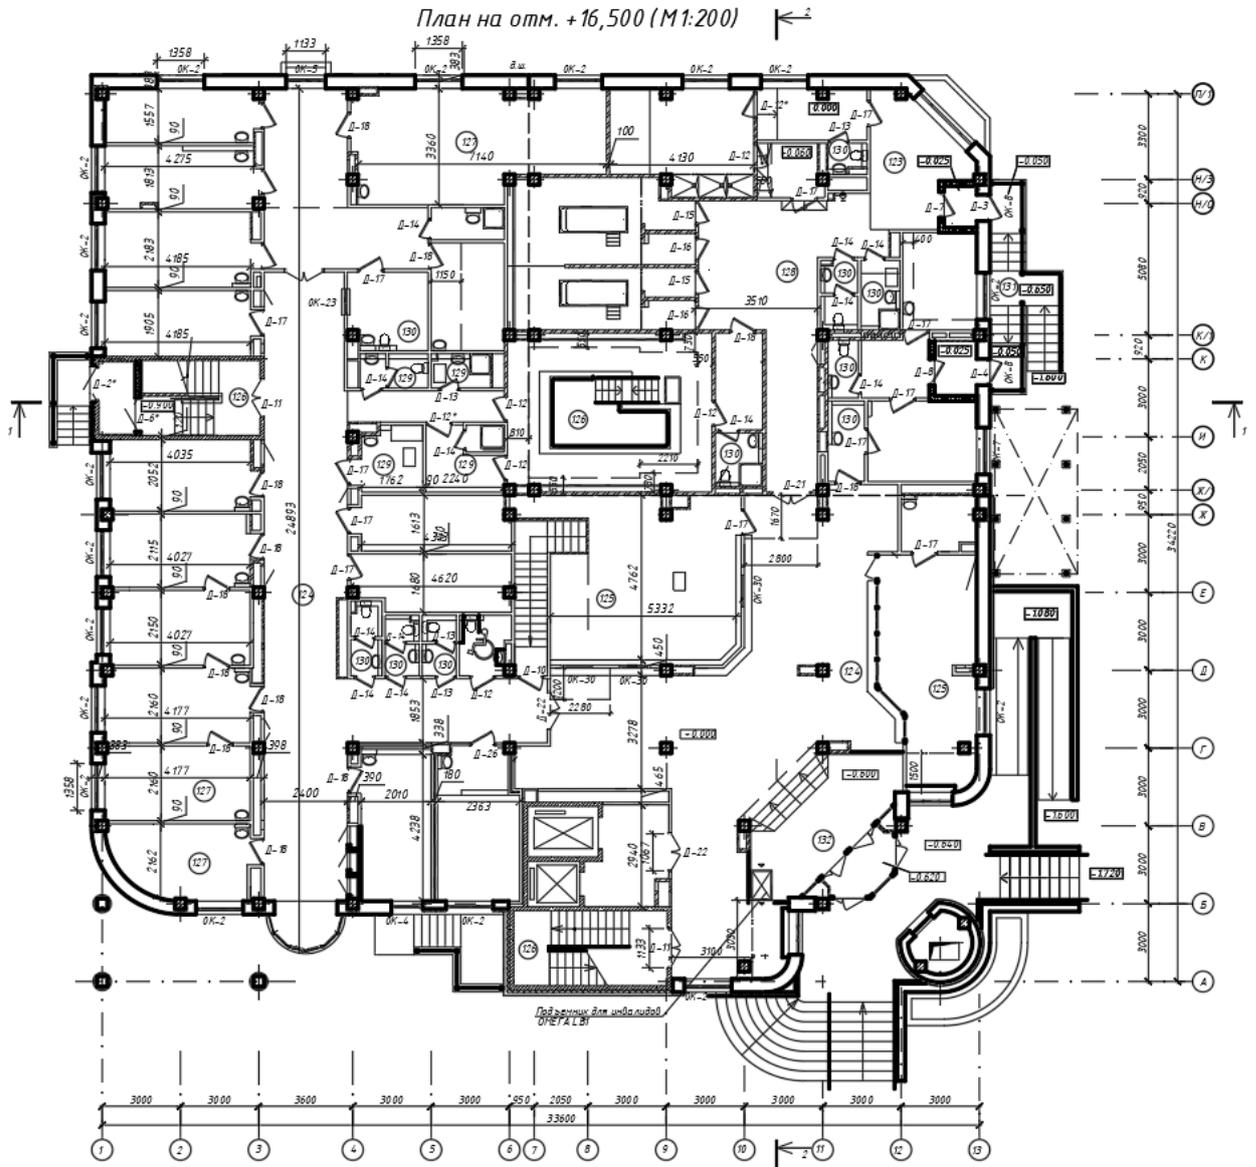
План шестого этажа (служебно-бытовые помещения) на отм. +16.500
